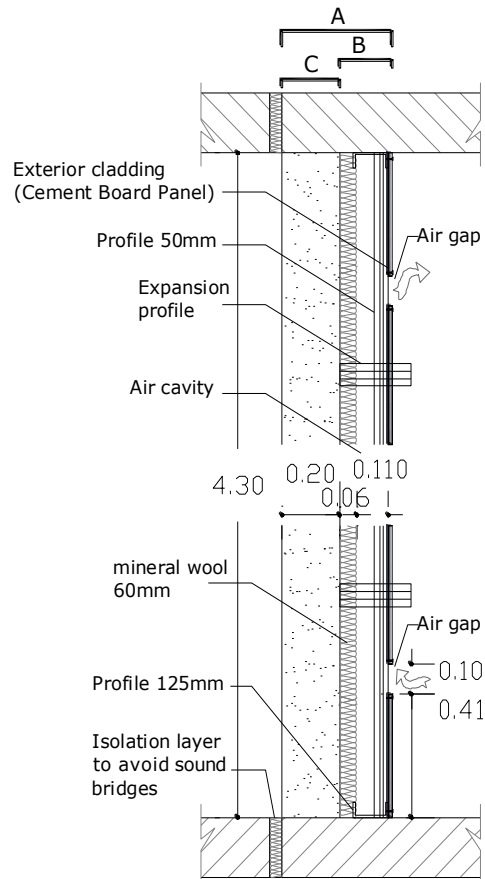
Vista en sección de la (FVL) instalada en LARGE. Sección con las aberturas de la cámara en la cara frontal de la hoja exterior (D)
